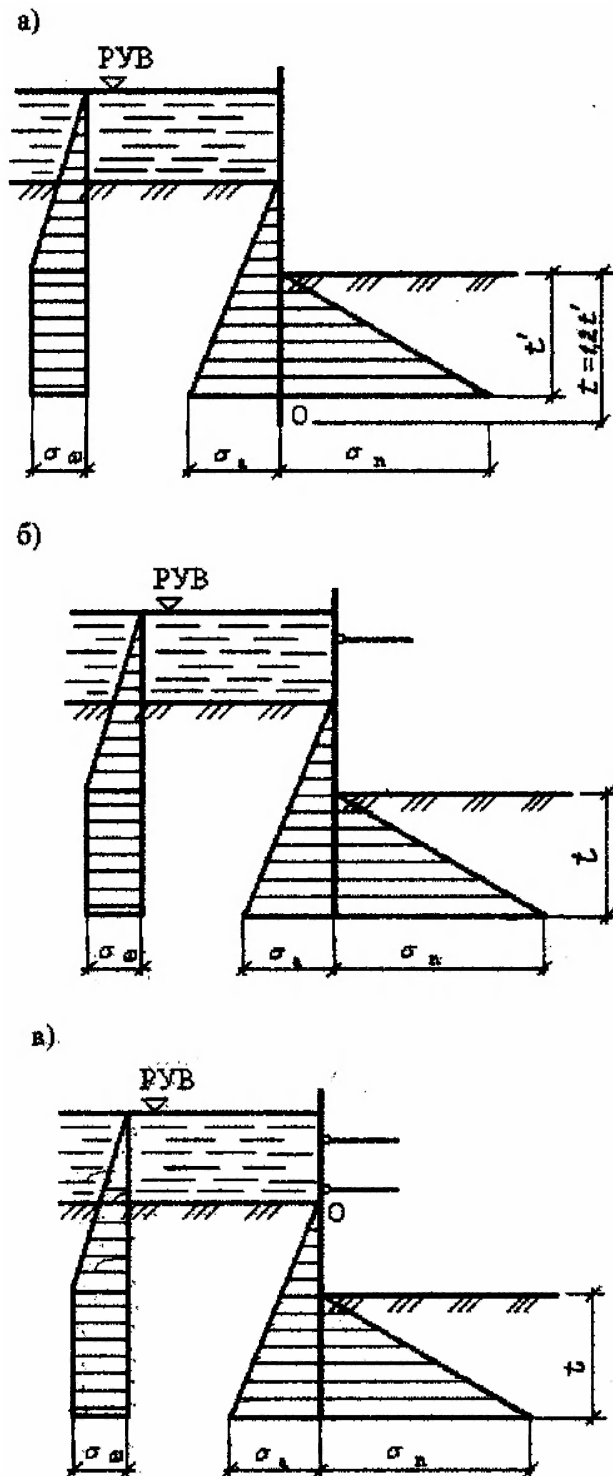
Схема к расчету глубины погружения ниже дна котлована
